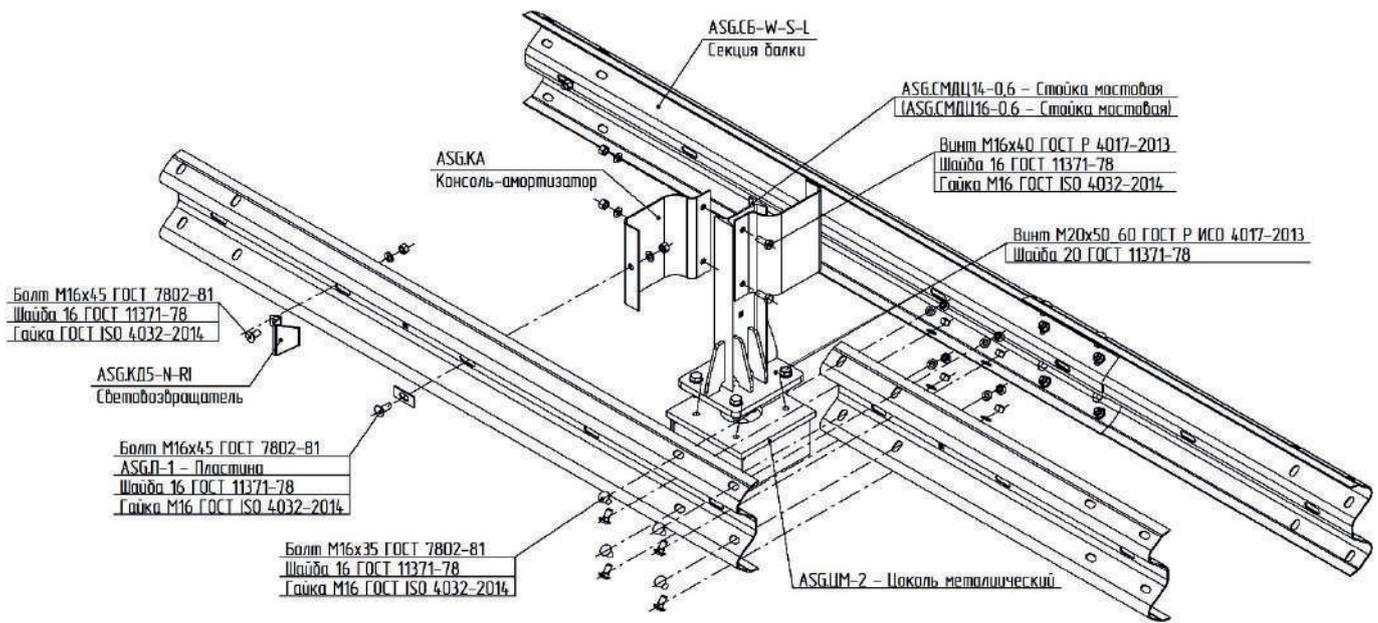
Схема сборки конструкций №12 и №13
